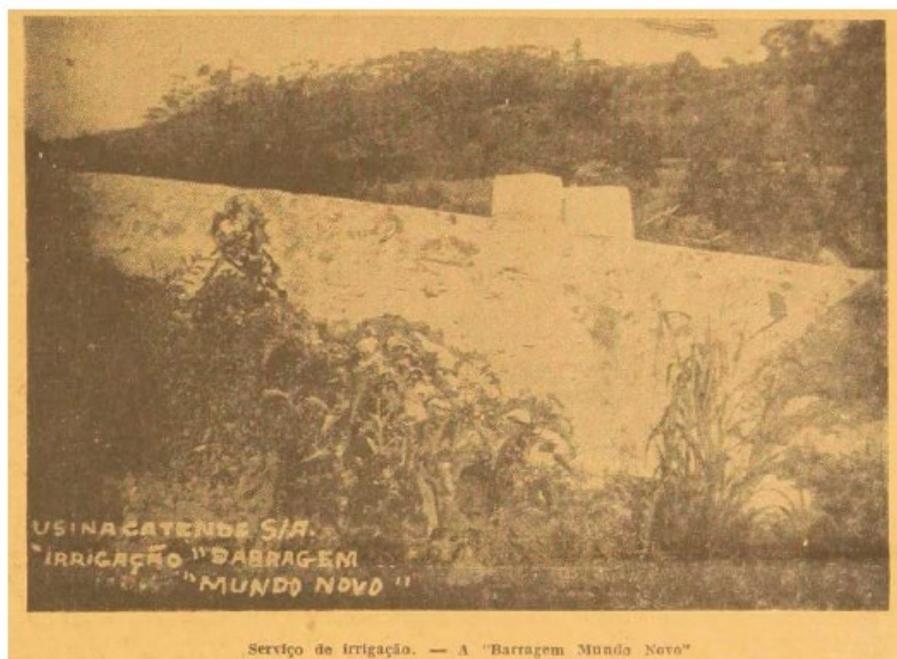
Obras de irrigação com a construção da barragem Mundo Novo¹⁰⁰
